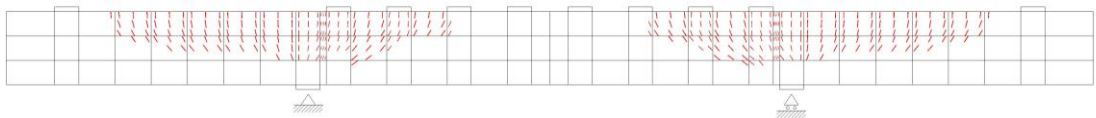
破壊時の変形及びひび割れ状態 (Case No. 14)
